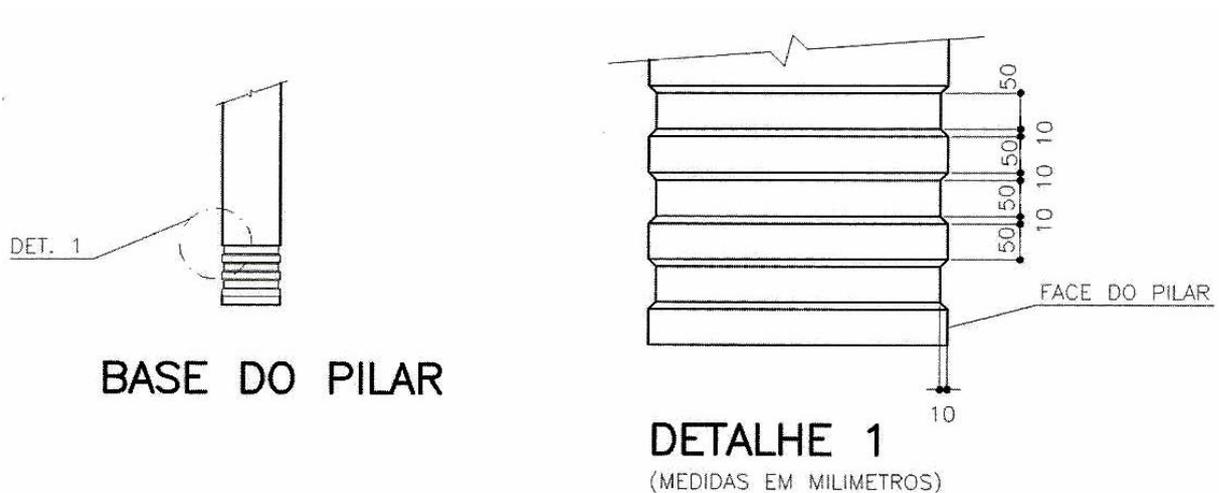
Exemplo de ranhuras na base do pilar.
